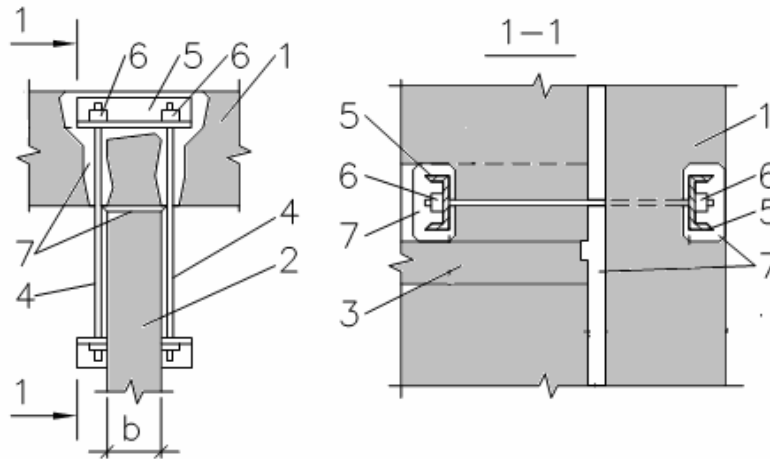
Восстановление сопряжений стен стальными затяжками: 1 – продольная стена, 2 – поперечная стена, 3 – перекрытие, 4 – тяжи, 5 – распределительные прокладки, 6 – гайки, 7 – цементный раствор
